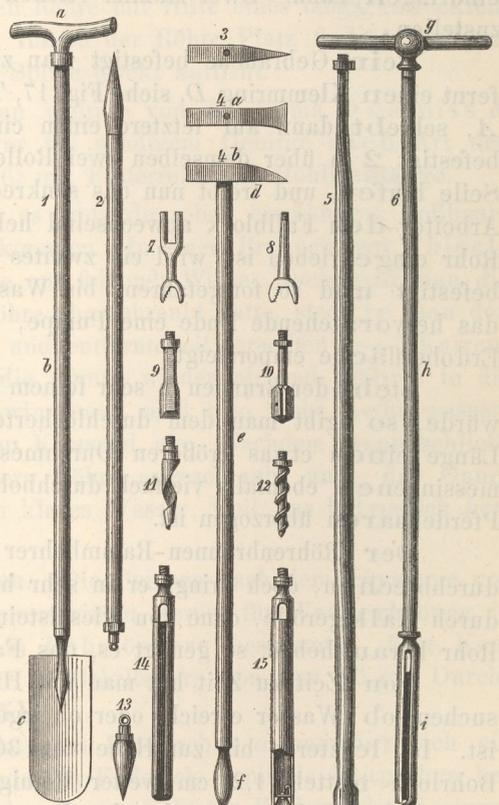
(9) zeigt einen Flachmeißel mit Seitenschneiden, welcher zum Durchstoßen fester Gesteine, Fig. 66 (10) einen Kronenbohrer mit 6 unteren und 6 seitlichen Schneiden, welcher in zerklüfteten festen Gesteinslagen angewendet wird, während der Schneckenbohrer, Fig. 66 (11), zum Vorbohren in verwittertem Schiefer und der Spiralbohrer, Fig. 66 (12), zum Auflockern von festem Kies dient.
